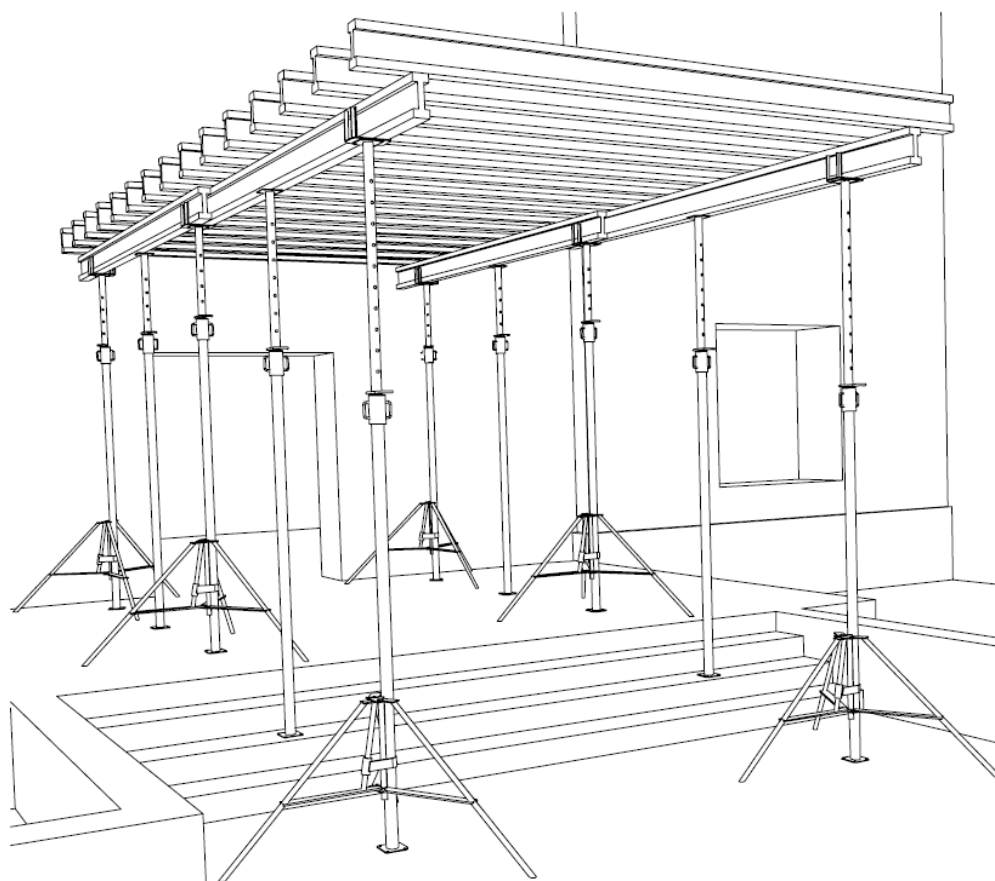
Опалубка перекрытий на телескопических стойках
